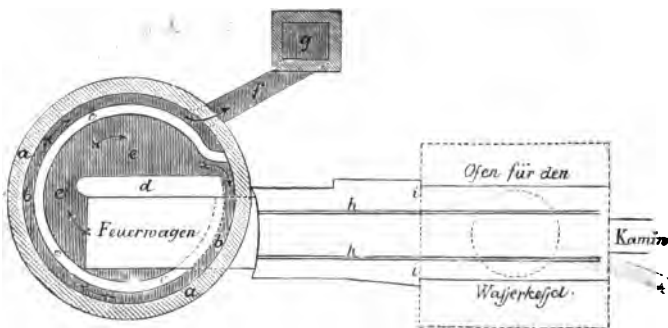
Eingemauerter Kessel — obere Ansicht.
